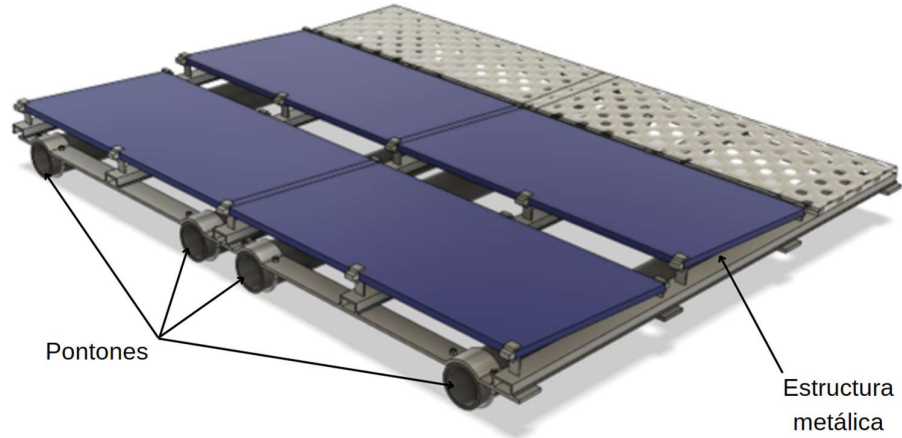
Sección esquemática del bloque fotovoltaico (estructuras 4 y 8).
